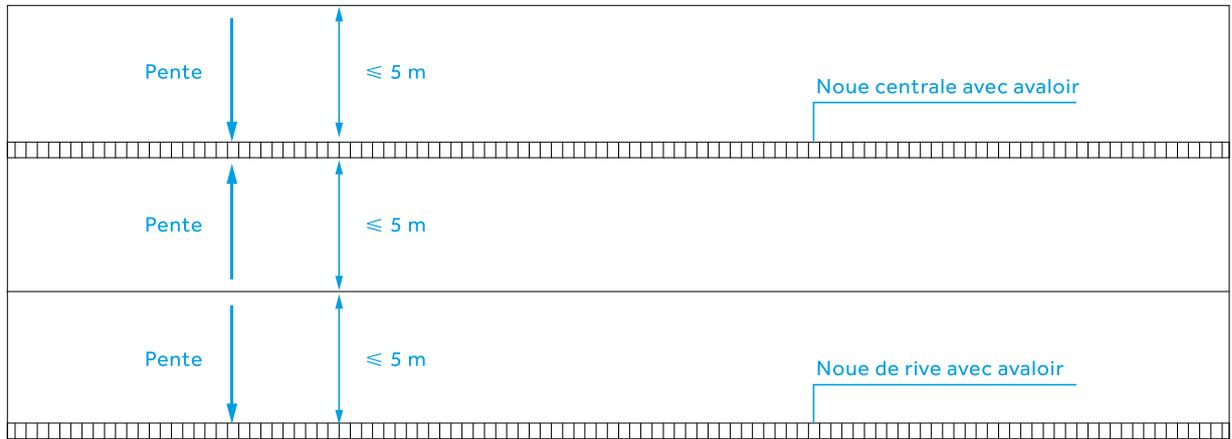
Toiture accessible aux piétons avec gravillons stabilisés
